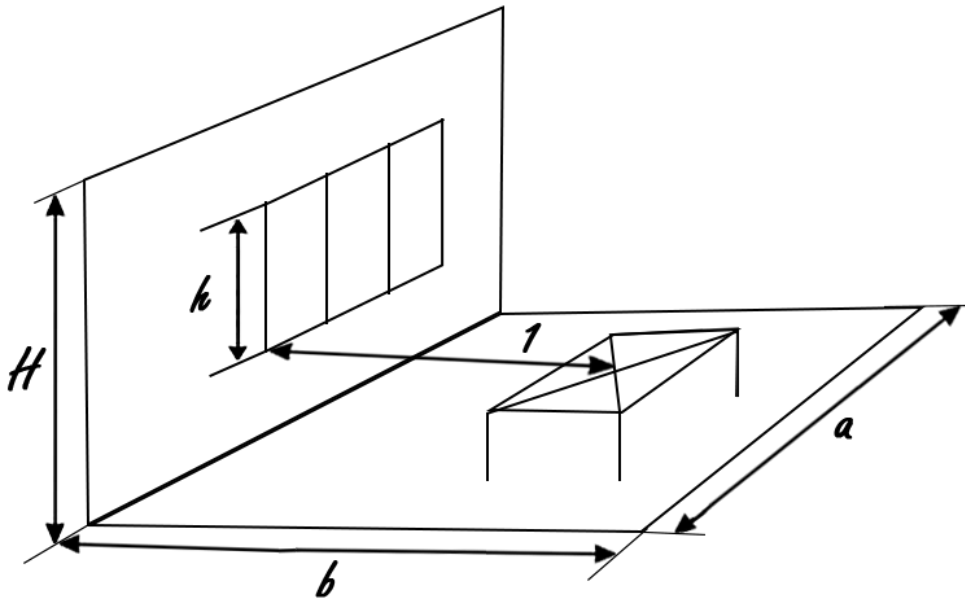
Розташування робочої поверхні у кімнаті
